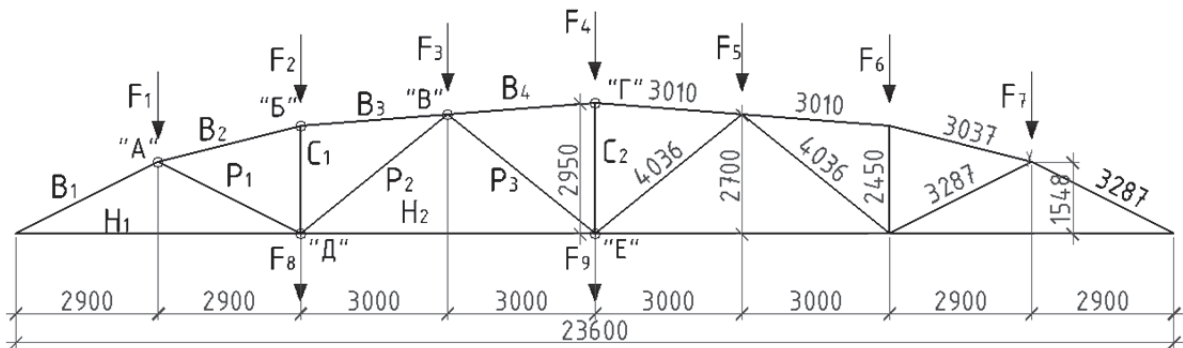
Геометрическая схема фермы пролетом 24 м
